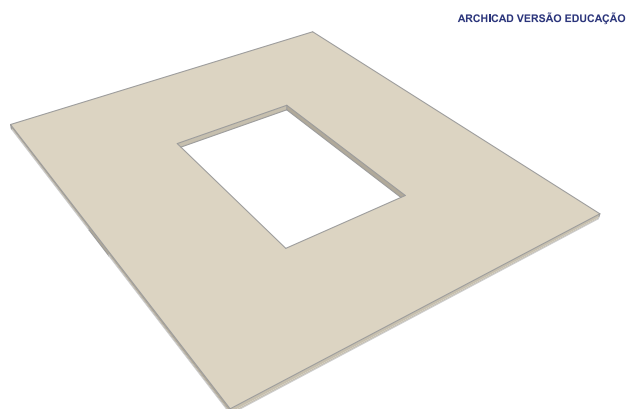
Dimensionamento de sistema da laje de fundação (Fonte: Autora)
